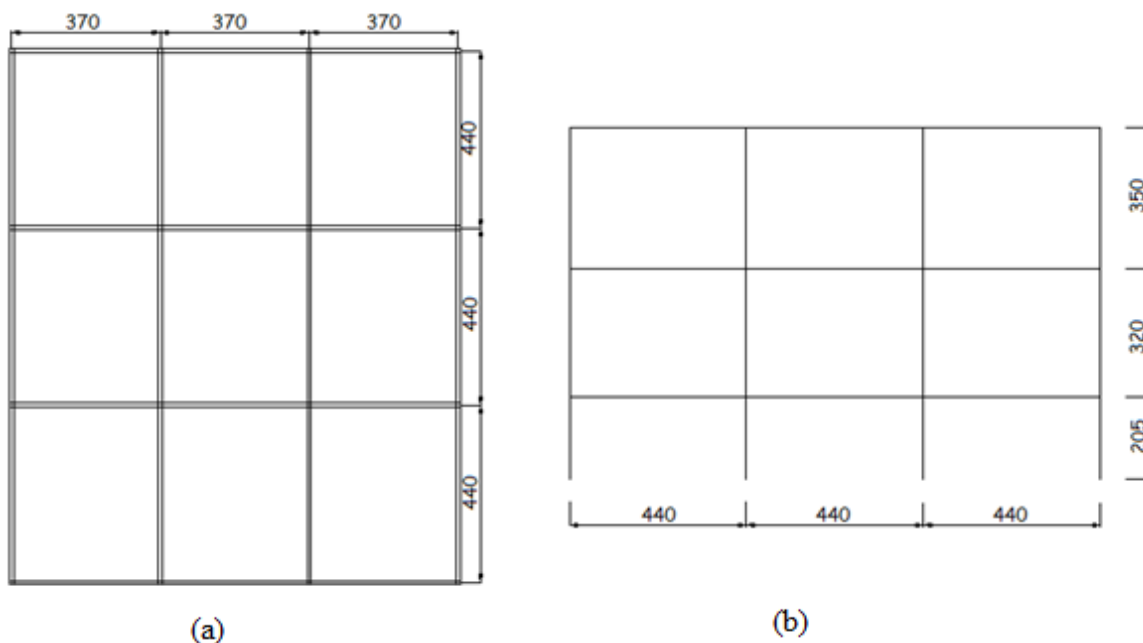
(a) Planta e (b) corte transversal da estrutura em estudo.
